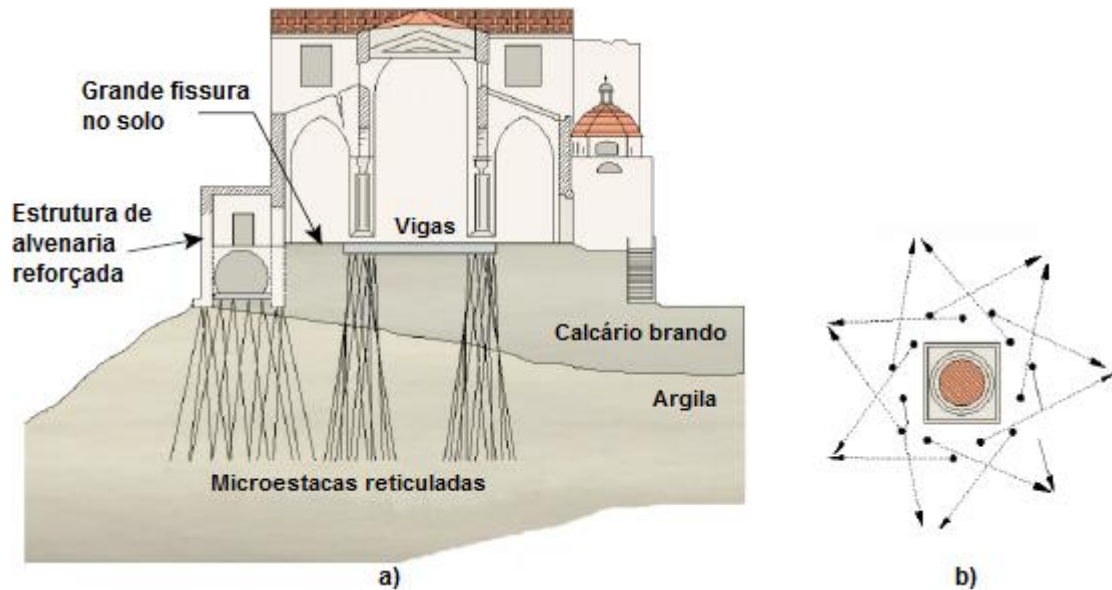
Estrutura reforçada pelo sistema “*reticuli di pali radice*”: a) alçado; b) planta do reforço das colunas [adaptado de 4]
